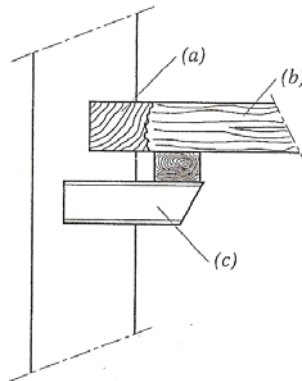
Exemplo modificação da posição de apoio com adição de consolo: extremidade de viga biodeteriorada (a), descarregada pela técnica de modificação da posição do apoio, movendo o ponto de apoio para a região da viga que esteja sã; (b) viga suportada sobre uma peça de madeira, que por sua vez é suportada sobre um consolo suporte com perfil metálico em forma de I (c), através de aparelhos de apoio de neoprene, destinado a evitar a condensação de umidade causada por diferenças de temperatura. Fonte: UZIELLI (1995)
